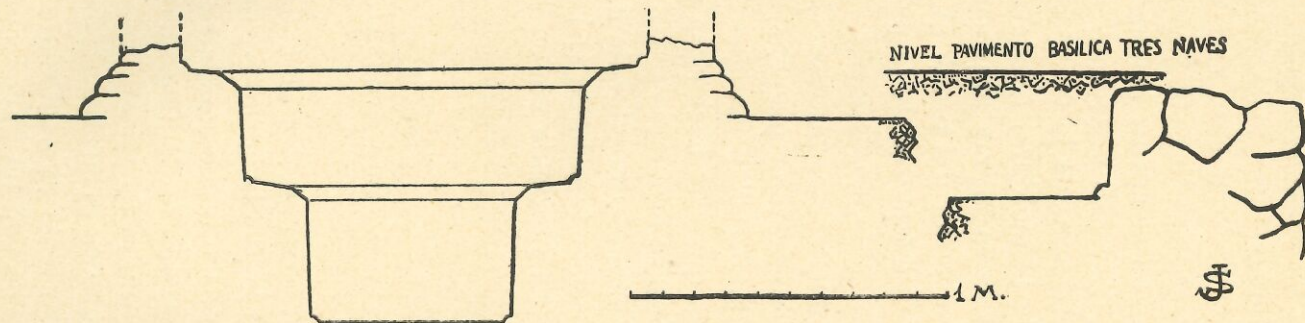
Sección de la pila bautismal y de los pavimentos del baptisterio.
